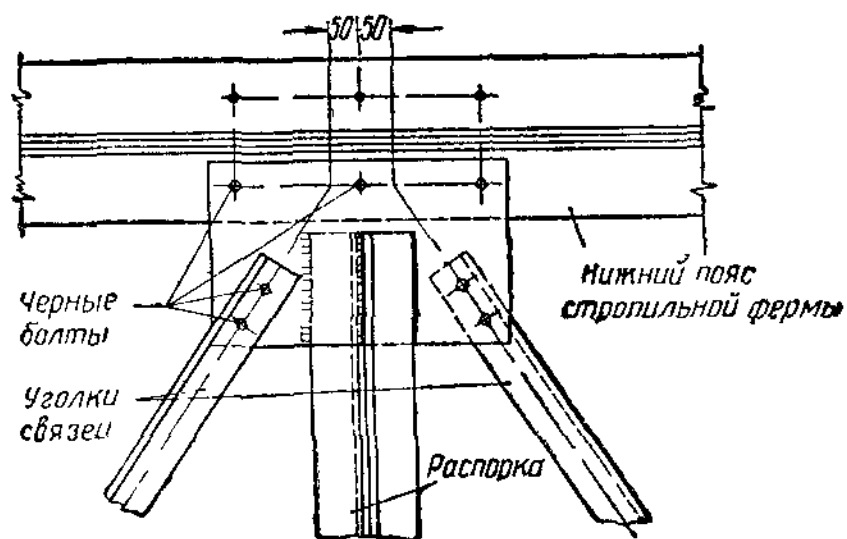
Прикрепление связей к нижнему поясу ферм на четырех болтах
